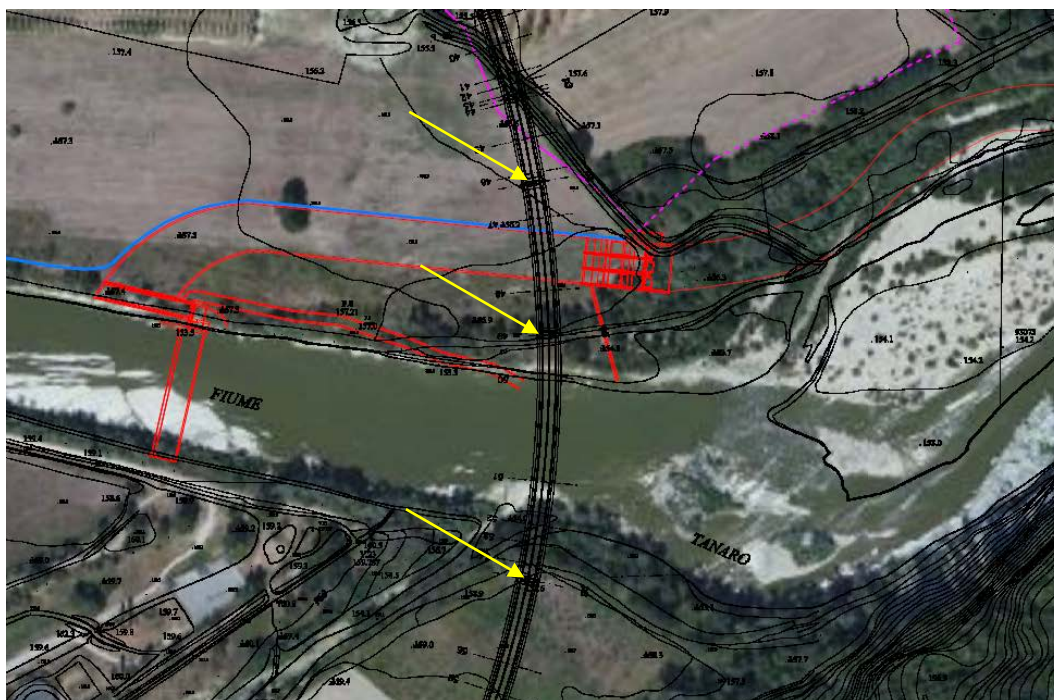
sovrapposizione del terzo ponte in progetto con la planimetria di progetto dell'impianto idroelettrico. Si evidenzia che le opere in progetto non interferiscono con l'attraversamento. Le frecce gialle individuano le pile.
